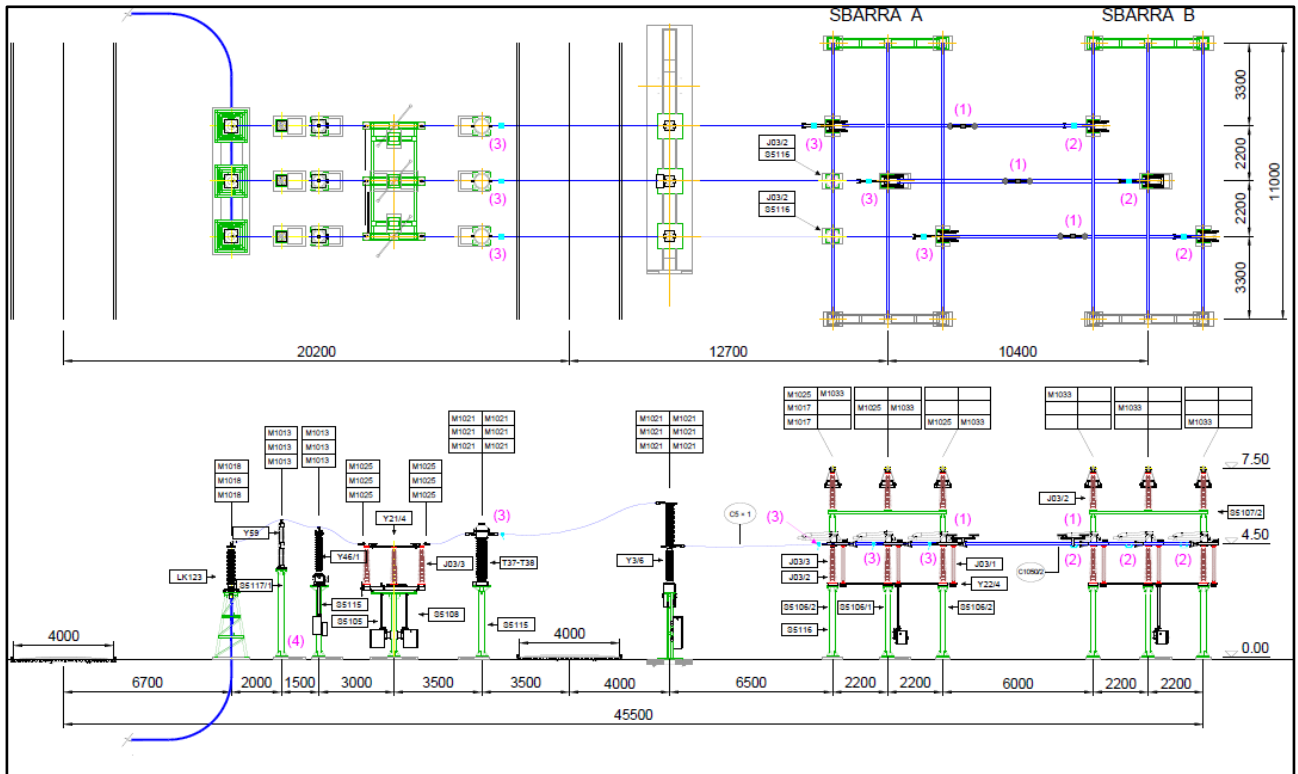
Planimetria e sezione elettromeccanica relativa alle apparecchiature dello stallo 150 kV nella stazione Terna
